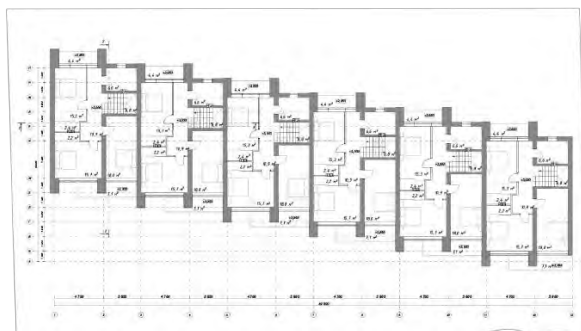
План 2 этажа проект таунхауса от компании House Expert [7]
